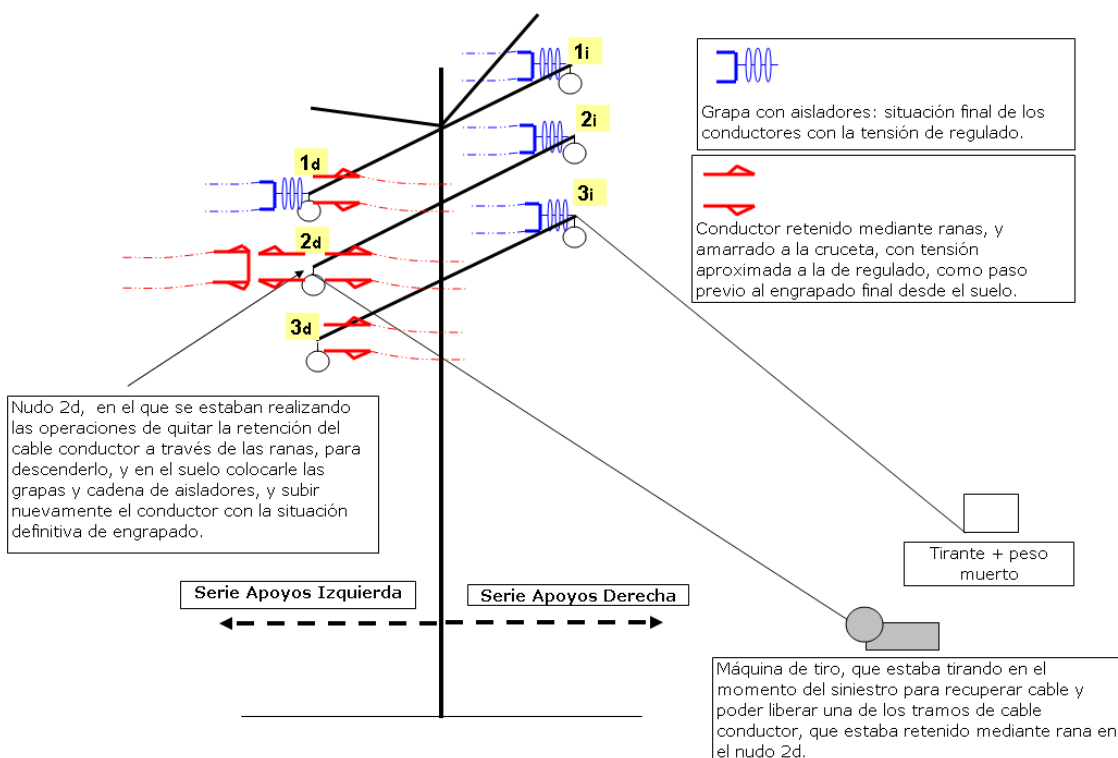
Situación apoyo metálico celosía instante anterior al colapso.
